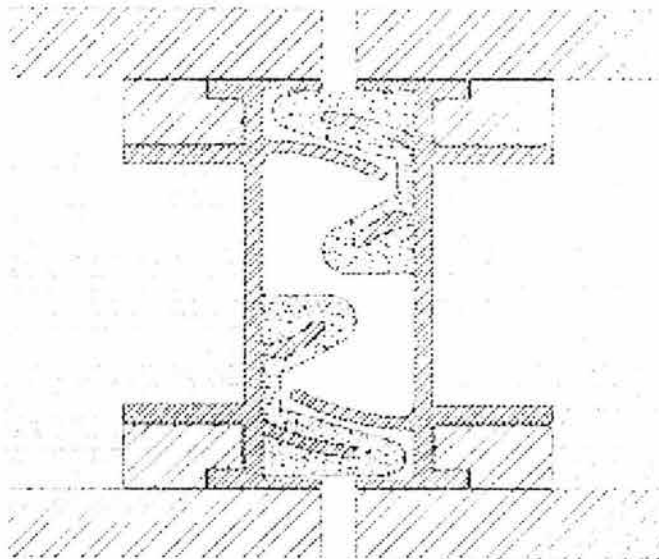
Detalle del ensamblaje de los muros por perfiles laterales, evitando cualquier puente fónico.
